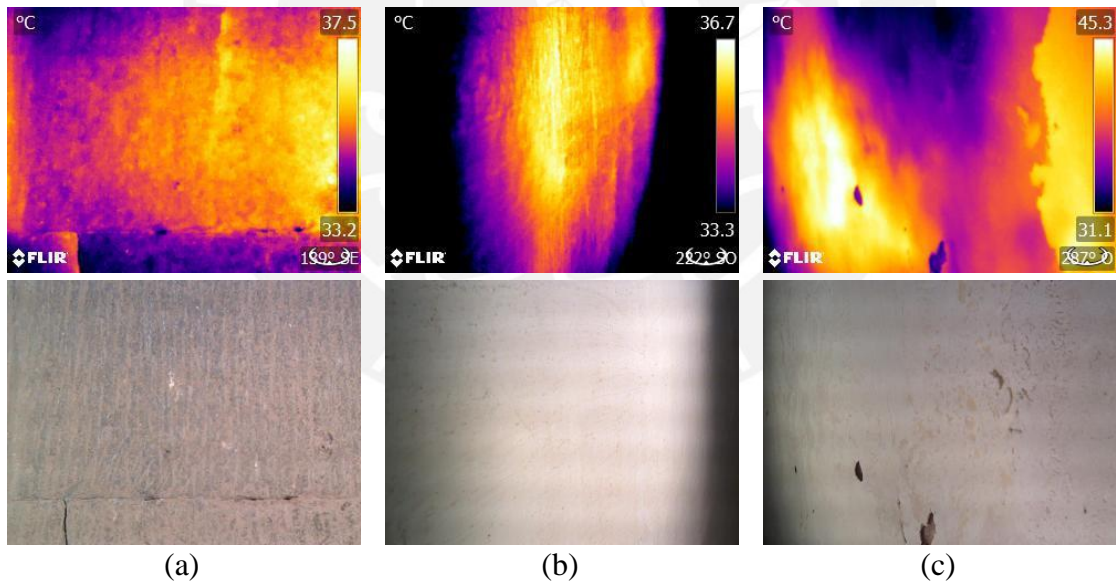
Anomalías estructurales detectadas con IRT activa: (a) grieta en bloque de piedra, (b) sillería localizada, y (c) abultamiento del recubrimiento de yeso
